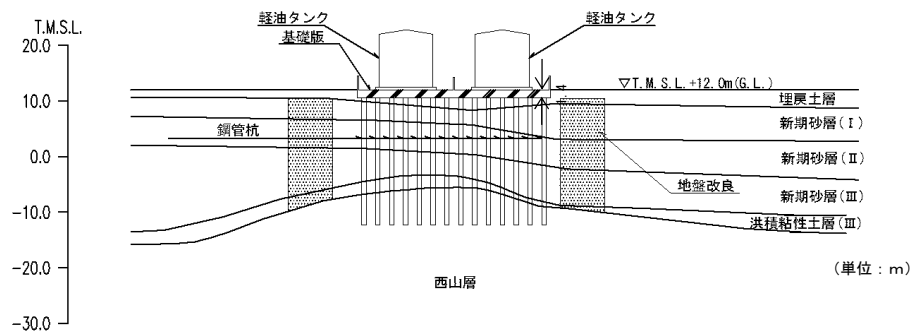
7号炉軽油タンク基礎断面図 (EW 断面)
